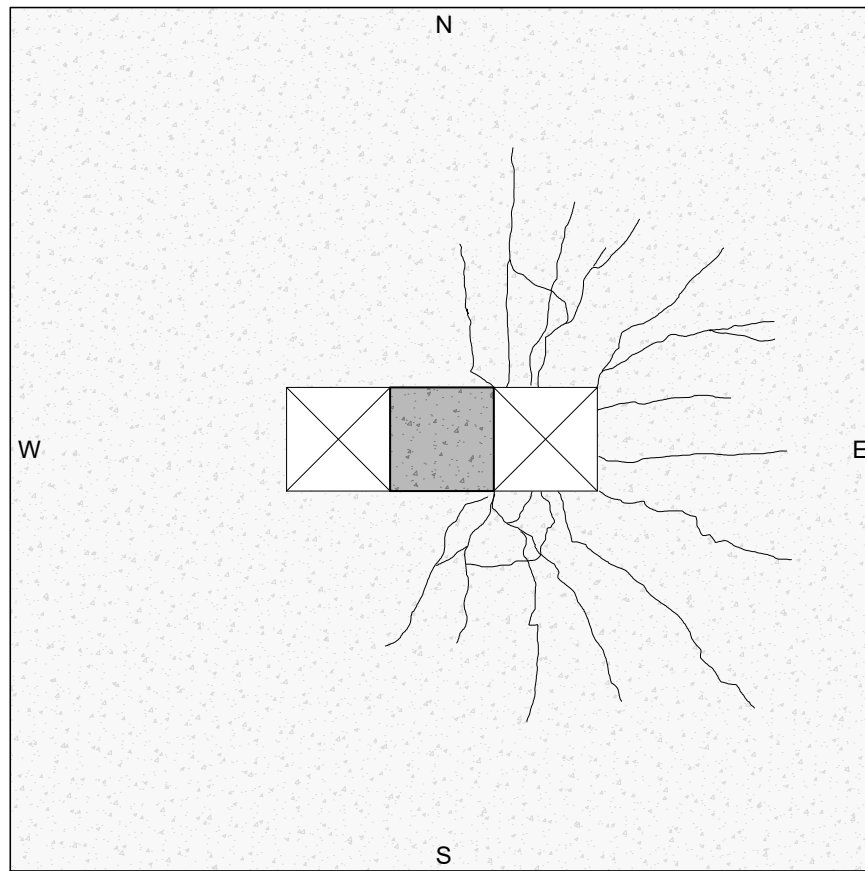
Padrão de fissuração da laje LFE3
